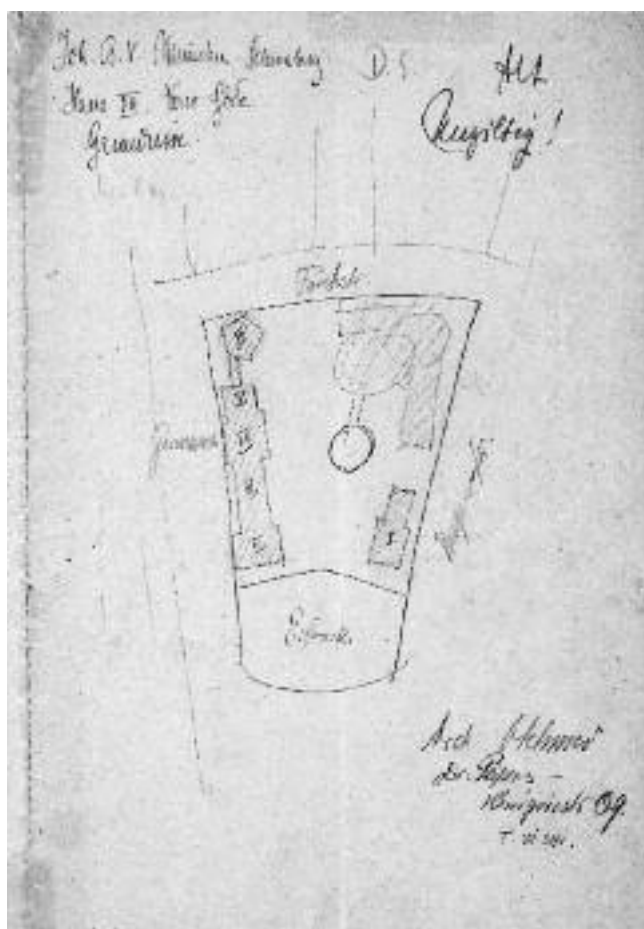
Skizze von Felix Peipers zum Lageplan des Johannesbaus. Rudolf Steiner Archiv
